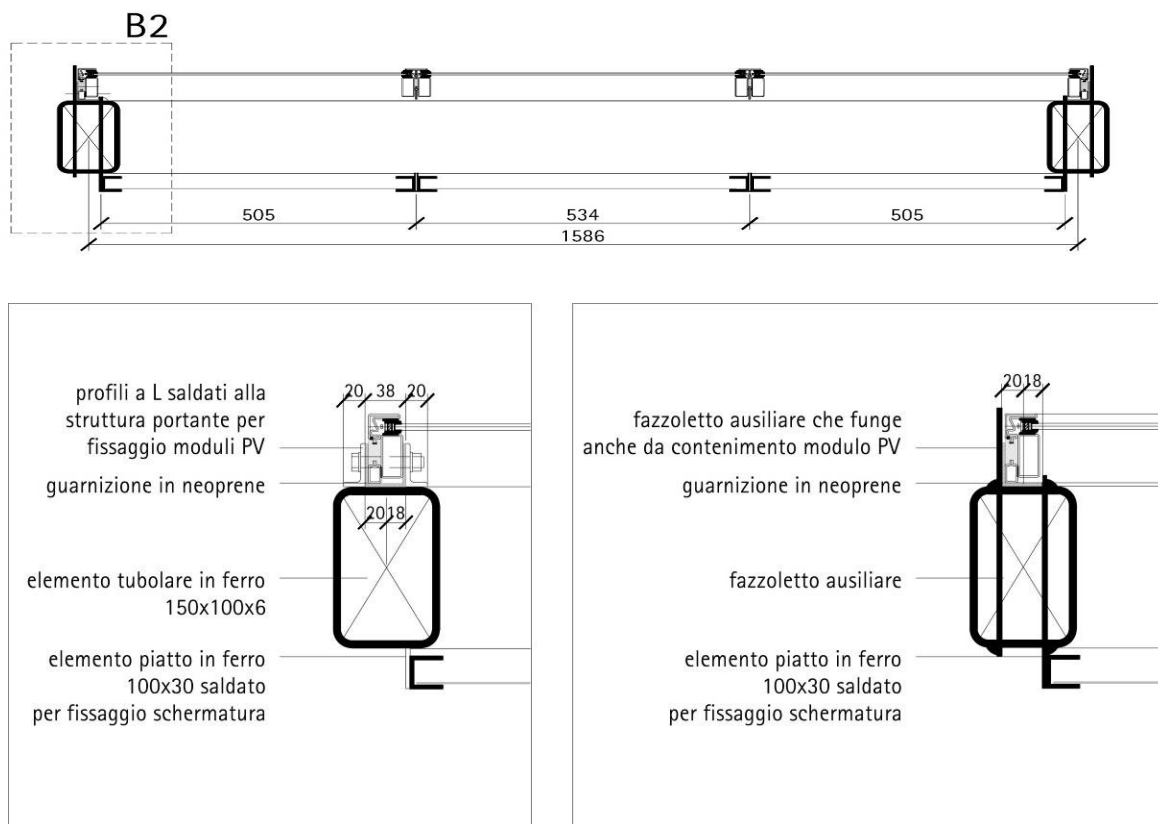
Sezione trasversale e dettagli dell'ala di copertura.
